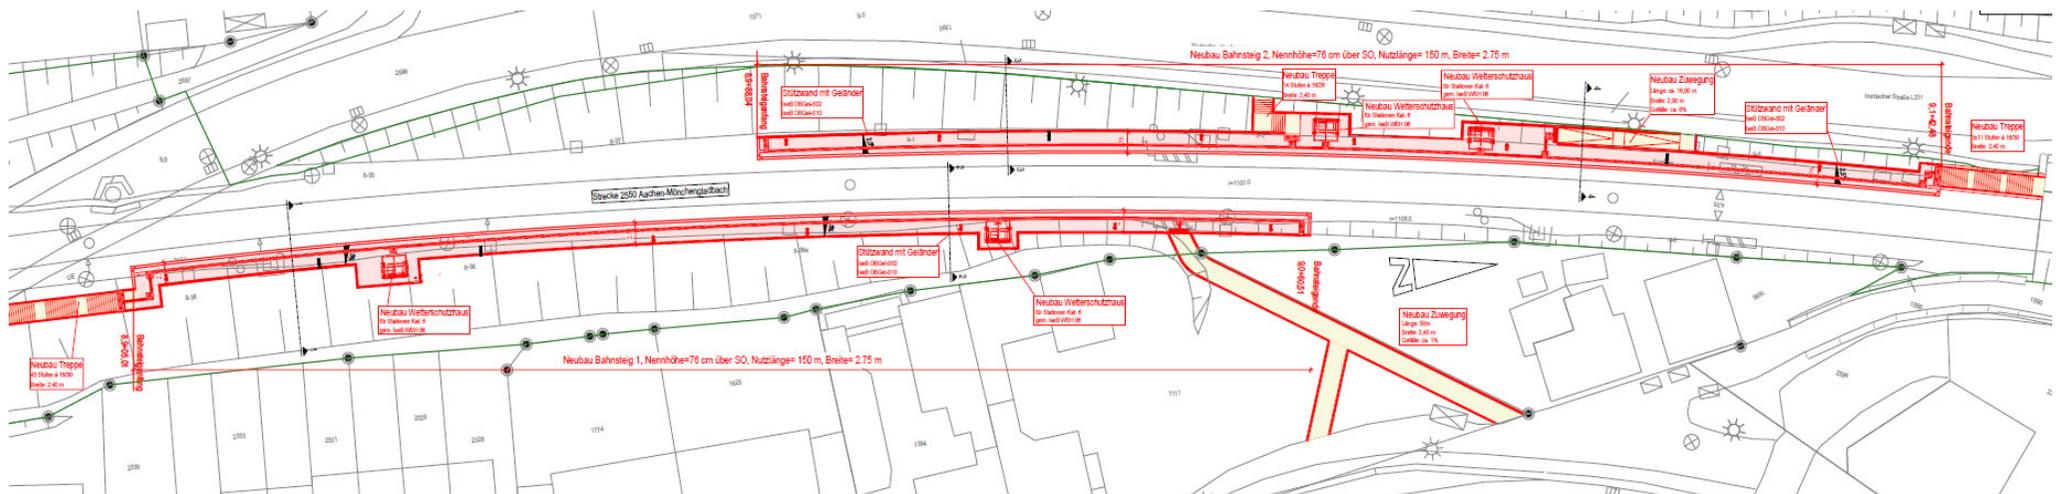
Lageplan aktuelle Planung (Stand: Abschluss Vorplanung)
